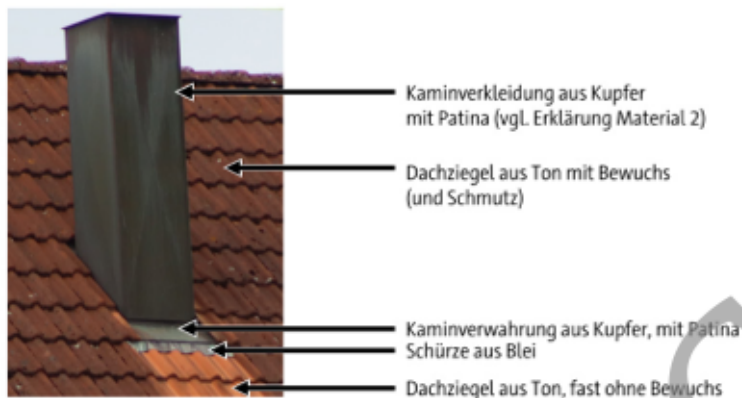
Älterer Schornsteinschutz aus Kupfer mit Patina und die Bezeichnung der einzelnen Bauteile
